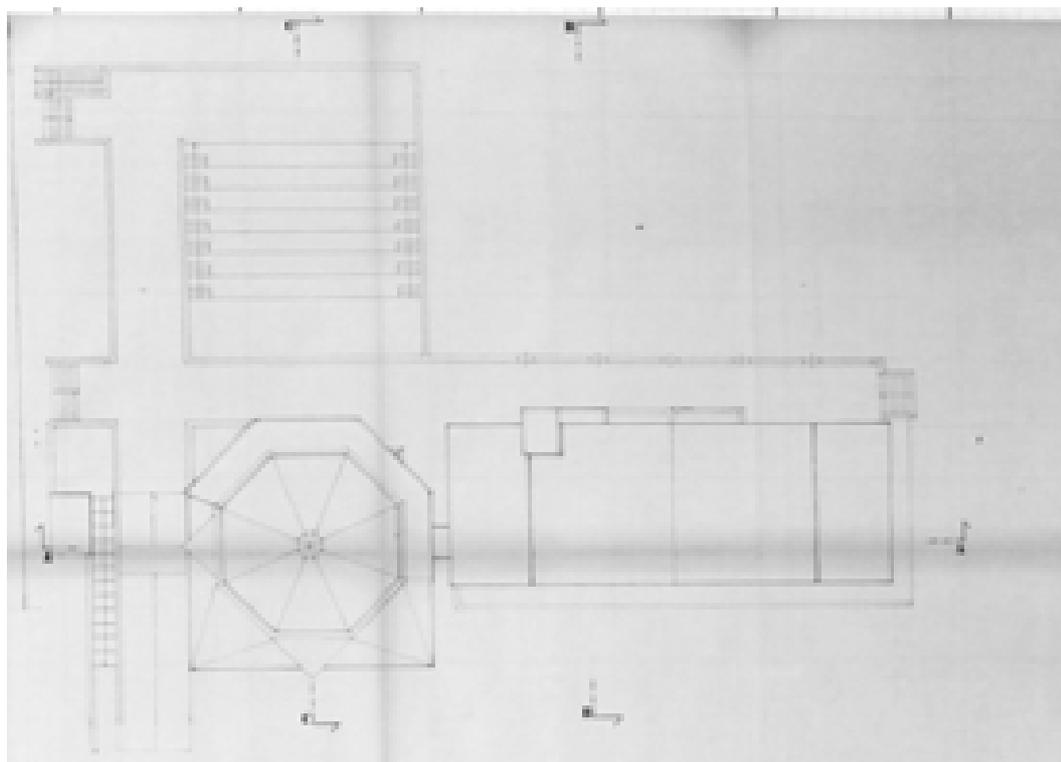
Pianta coperture, stato attuale – 28/03/1995 (AABS-64_840)
